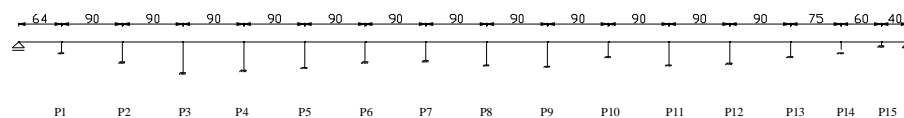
Esquema estrutural da ponte (alçado).
